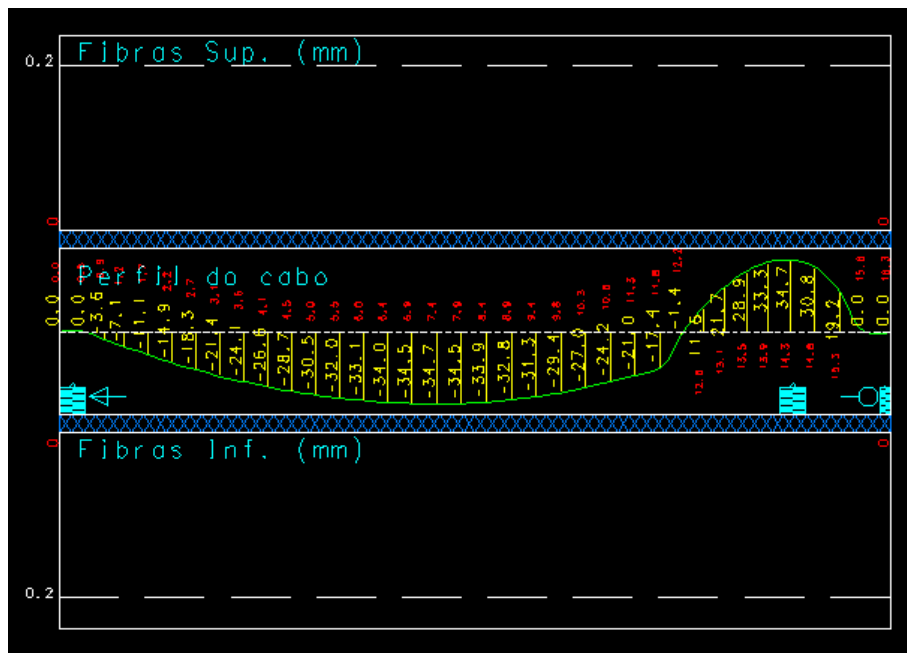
Fissuração viga V8 do subsolo (CAD/TQS)
